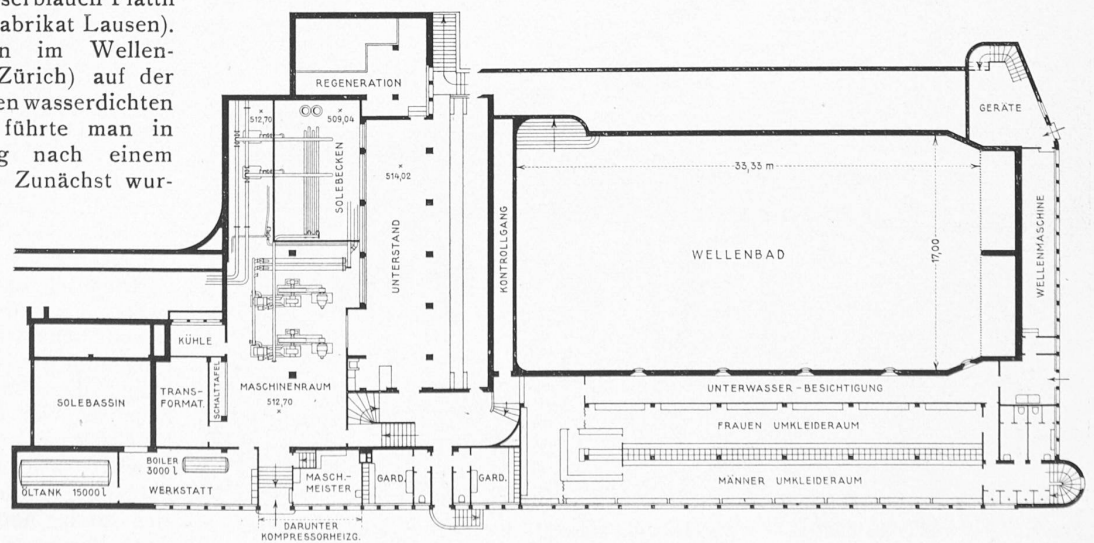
Grundriss vom Untergeschoss des Gebäudes. — Masstab 1 : 500.
